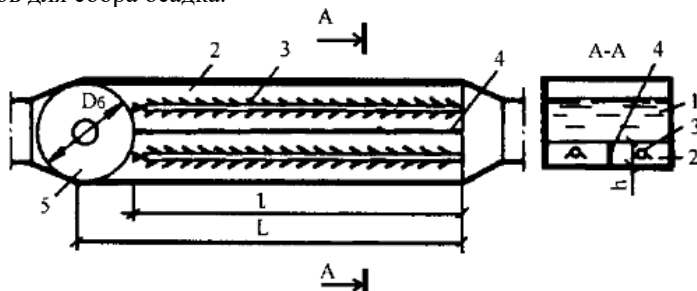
Схема горизонтальной песколовки с гидромеханической системой удаления осадка:
